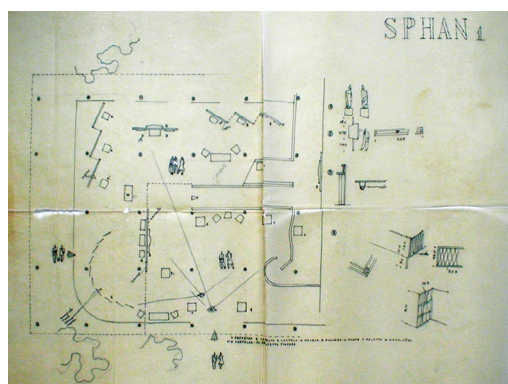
Croqui de instalação da exposição *Arte Tradicional Mineira*. Pavimento térreo.¹³⁵
